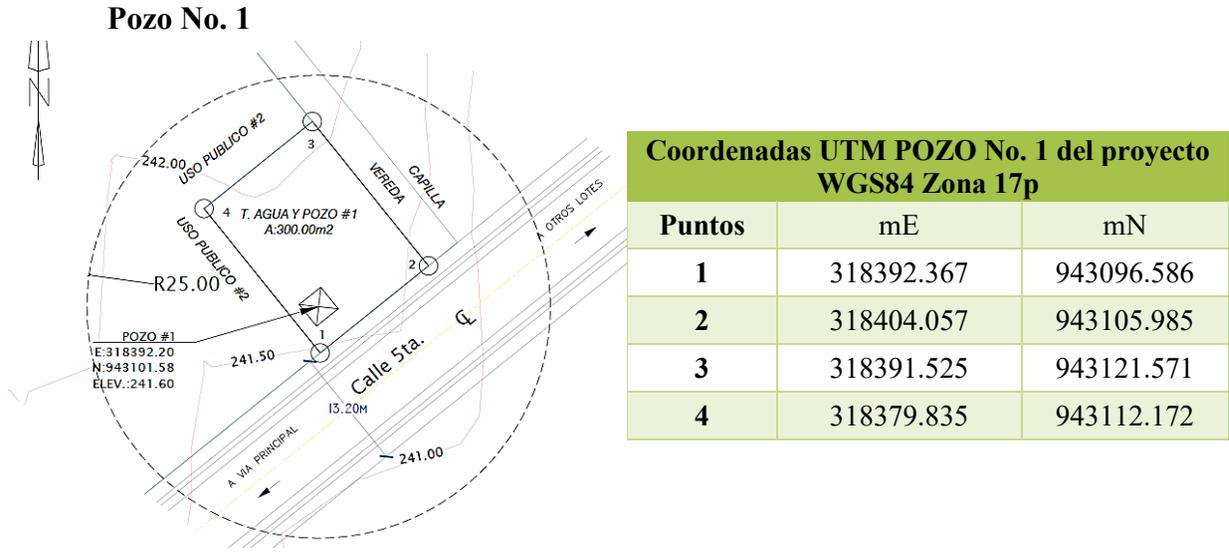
Coordenadas del pozo y tanque de reserva No. 1. Fuente: Planos del proyecto, 2023
